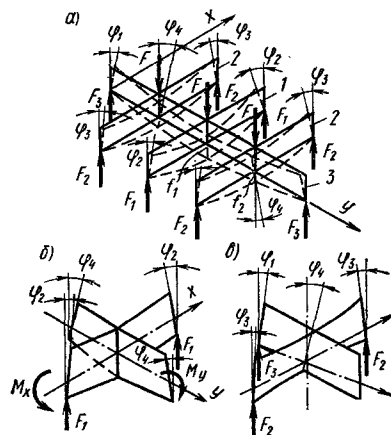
К работе перекрестных ферм (1—3) на кручение (а—в)
